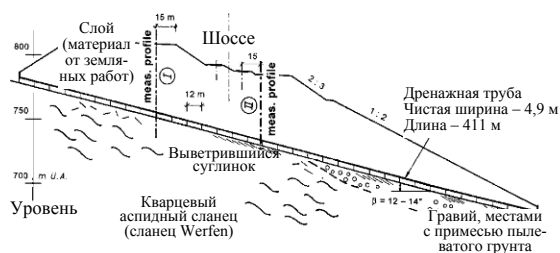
Поперечный разрез высокой насыпи с двумя профилями измерений для определения напряжения на дренажную трубу, заложенную в основании насыпи
